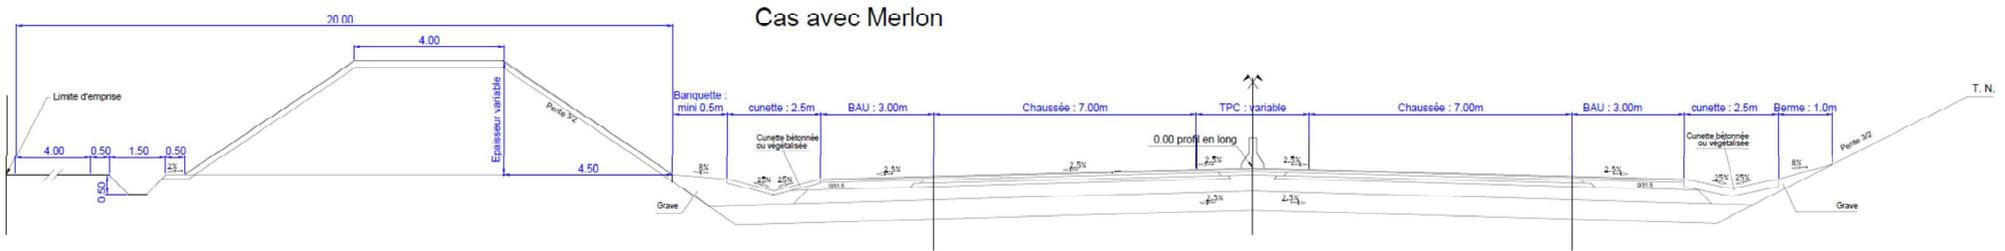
PROFIL EN TRAVERS SECTION COURANTE - CAS AVEC MERLON (SOURCE : ÉTUDE PRO)
